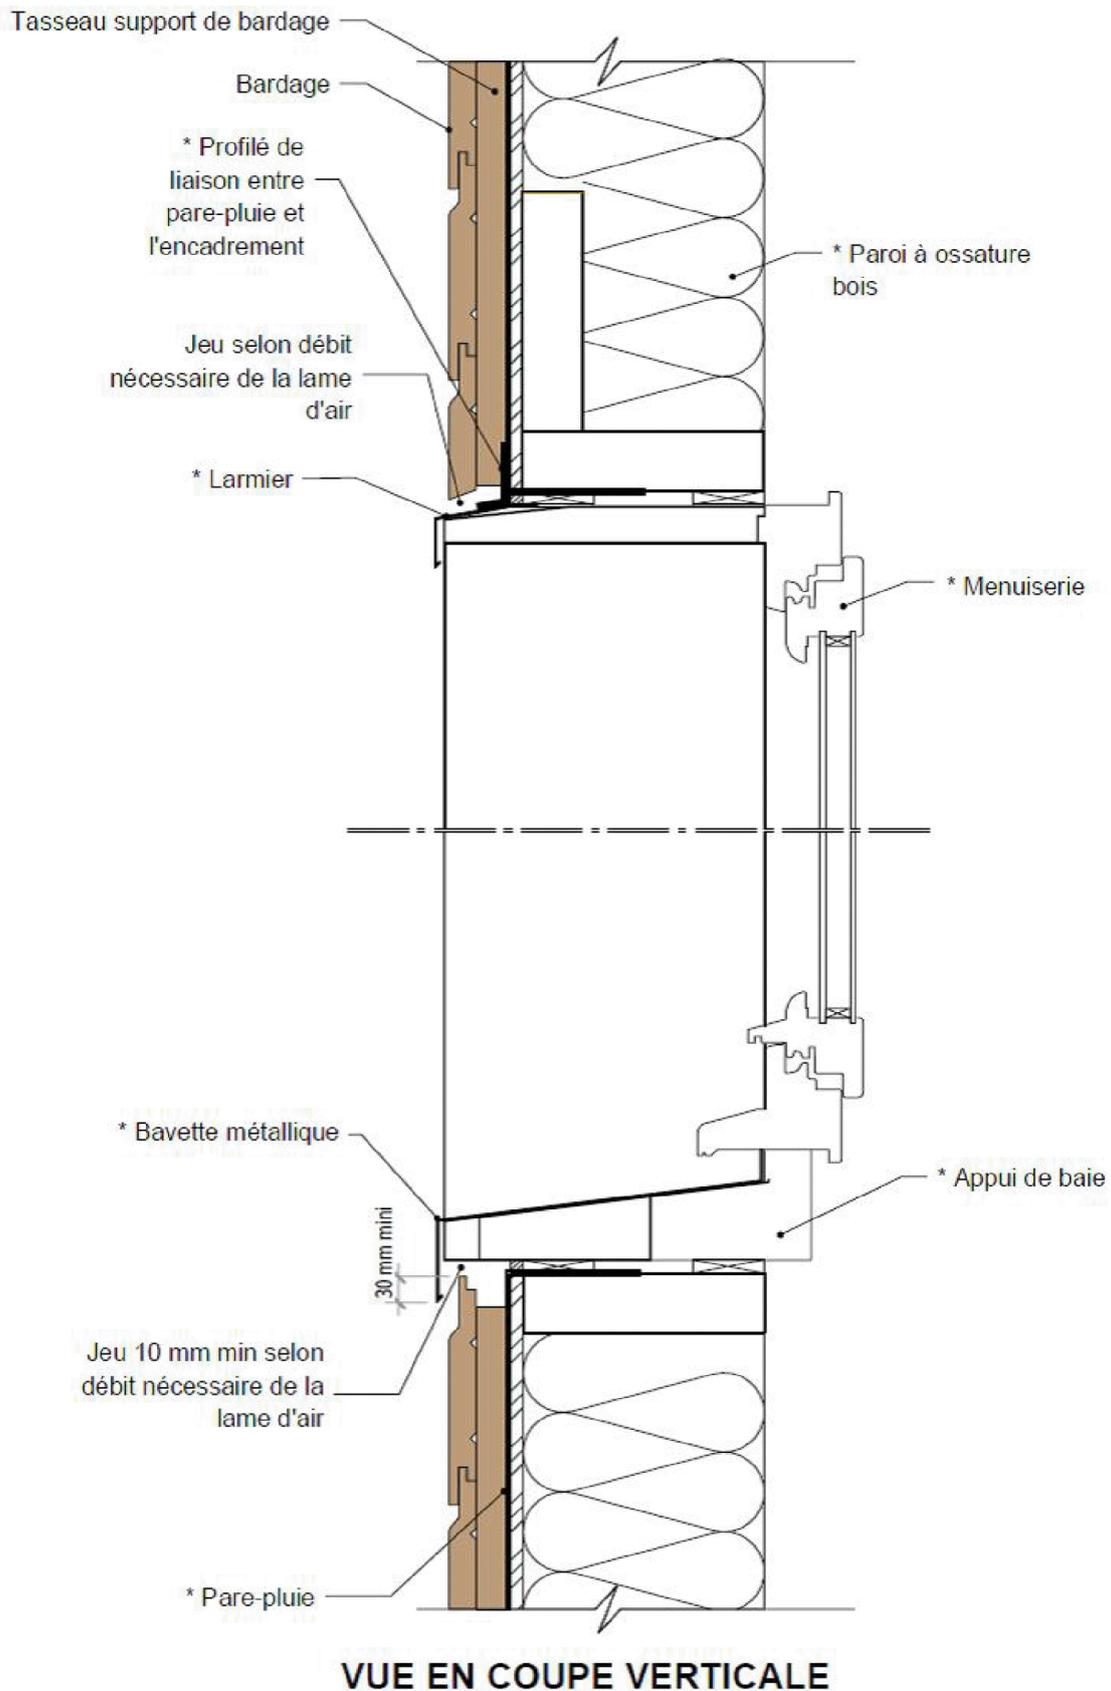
Protection du calfeutrement par un profilé de liaison – coupe verticale
